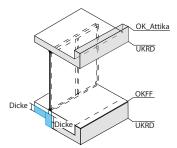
Geschossdecke, Deckenversprung, Balkon ²²
